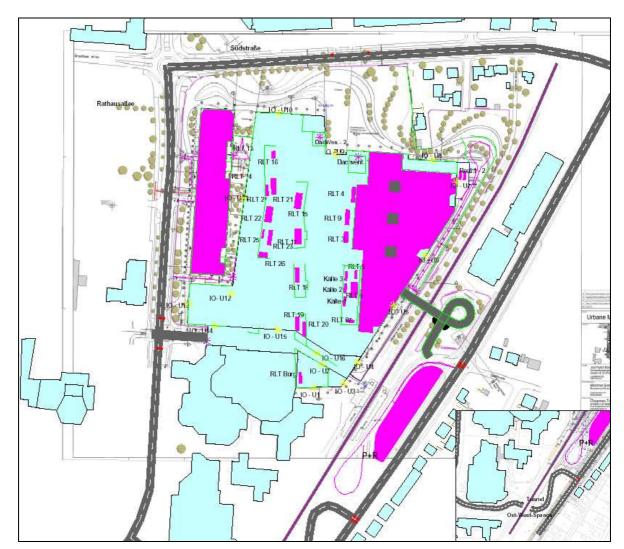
Lageplan – Immissionsorte im eigenen Bereich
